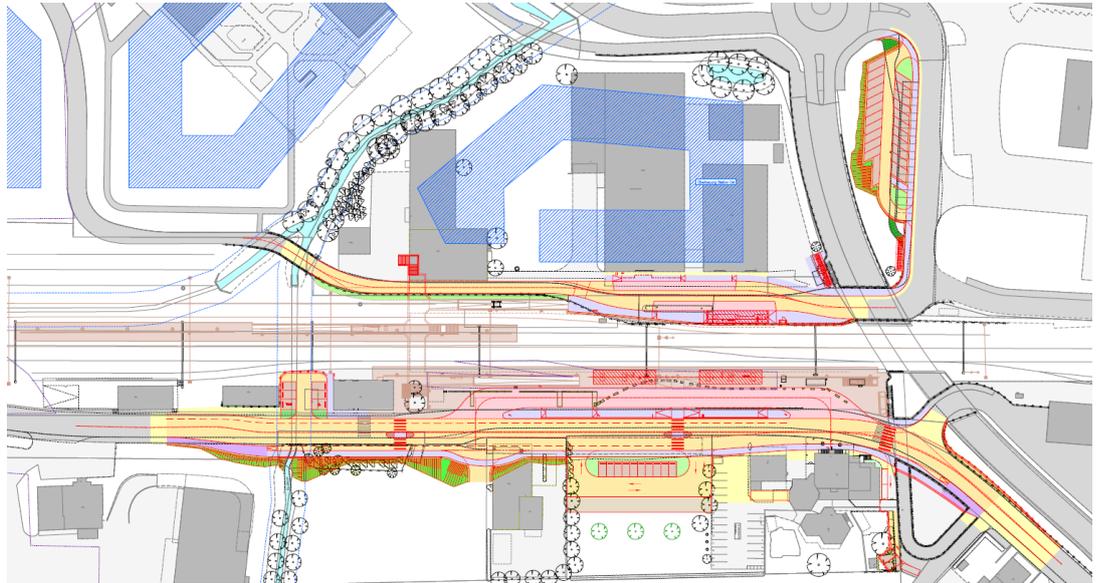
Detailübersicht Infrastrukturausbau Bahnhof Rothenburg Station
